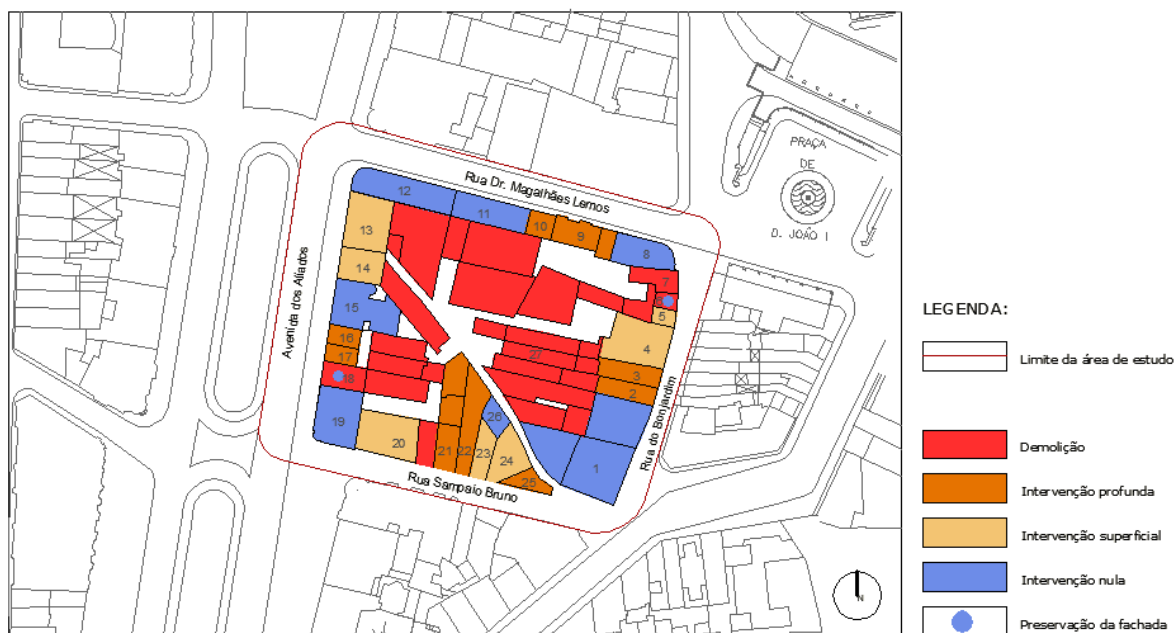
Planta da análise do tipo de intervenção no edificado existente. Fonte: Autor.
